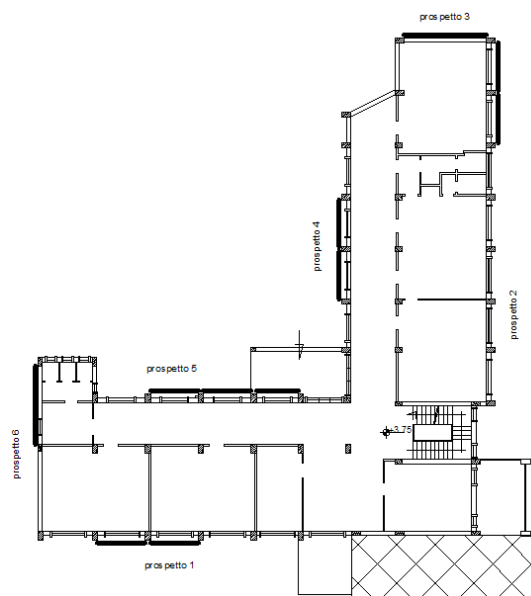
Disposizione planimetrica tipo dei controventi evidenziati in nero per i casi A, B, C.
